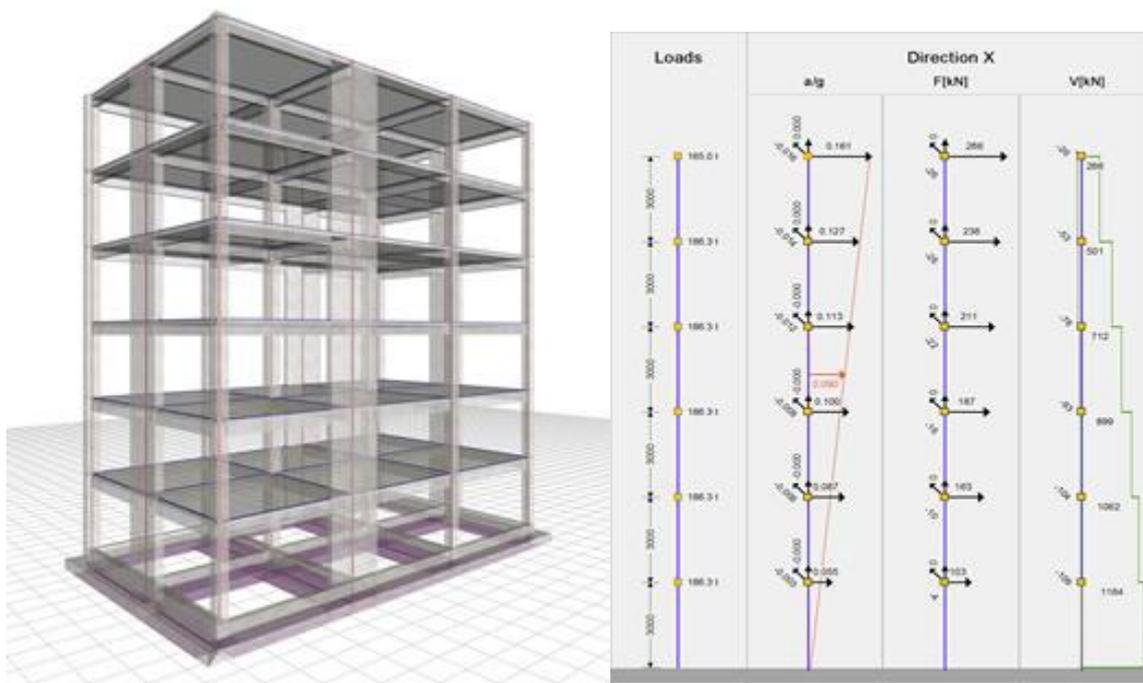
Конструктивна схема будівлі з несучим каркасом і стінами, що спираються на балочний фундамент
